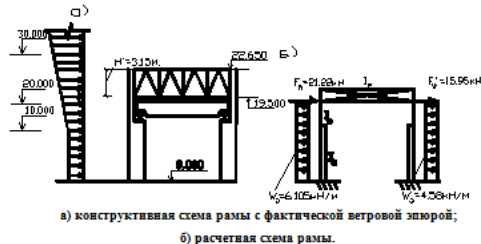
К определению ветровых нагрузок (нагружение № 3)
